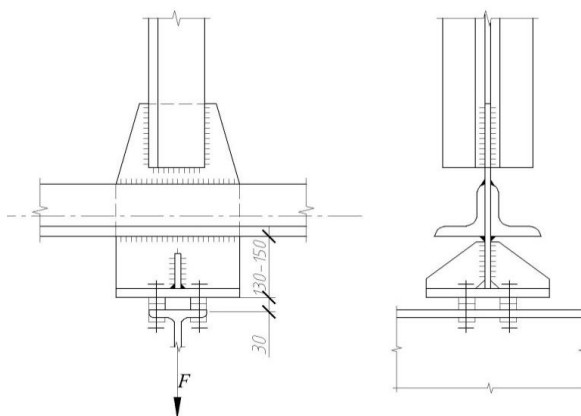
Крепление балок подвесных путей к стропильным фермам
